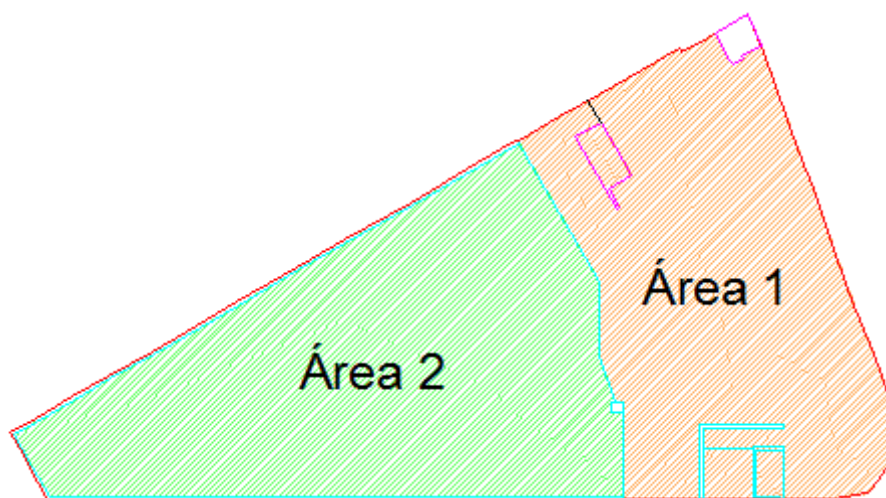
Divisão dos pisos em duas áreas pelo plano de betonagem
